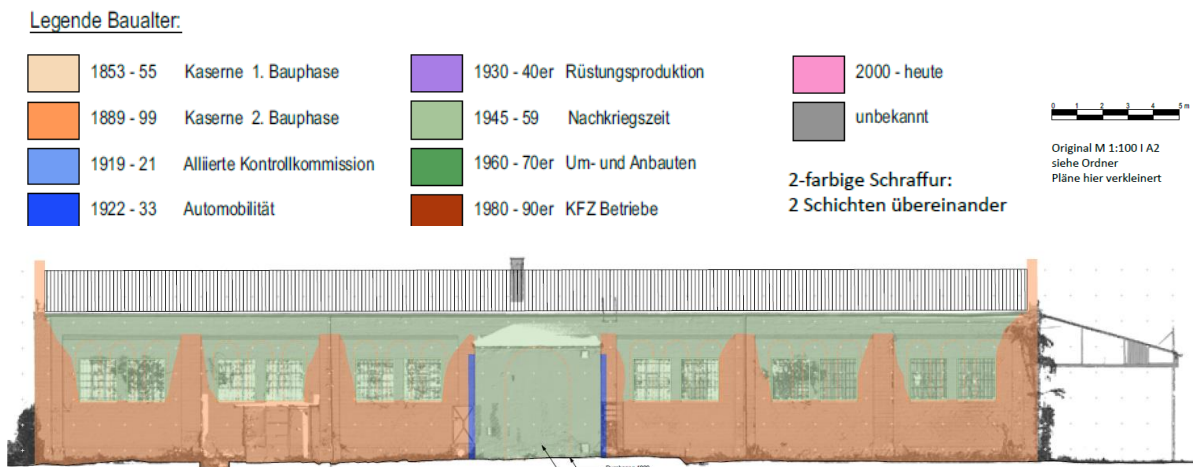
Neue Reithalle, Ansicht Ost mit Kartierung der Bauepochen (Auszug Denkmalpflegeplan, 2020)
